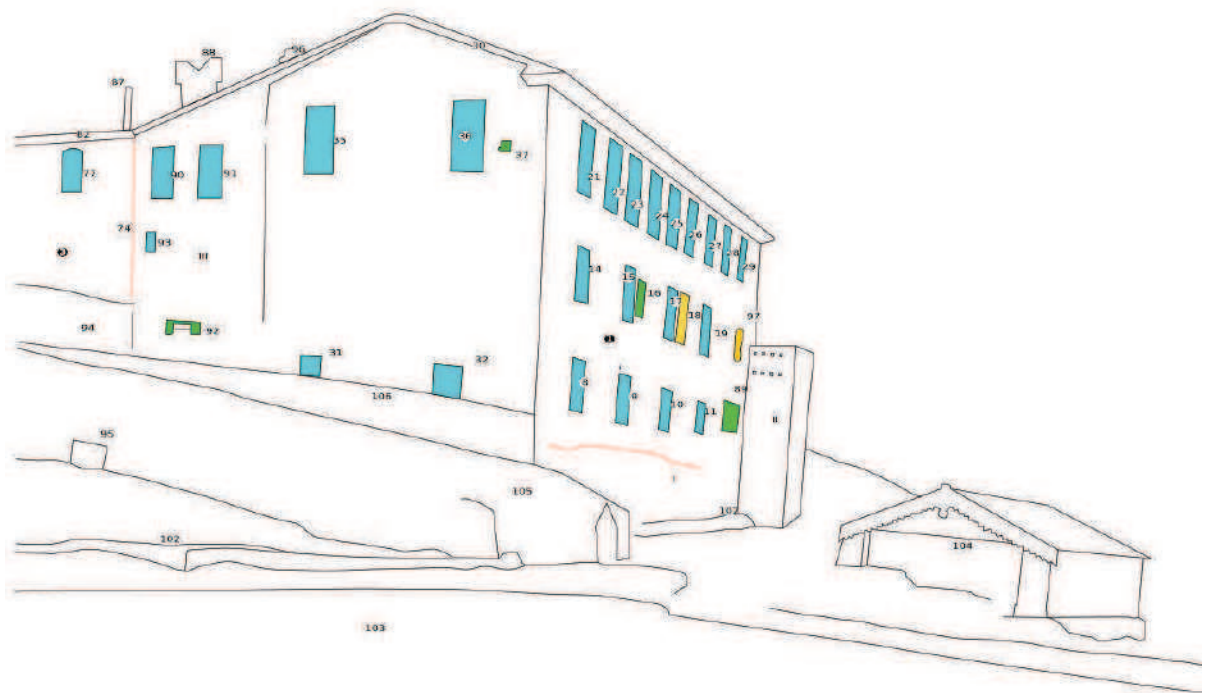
Croquis de la leyenda de elementos de la fachada.
